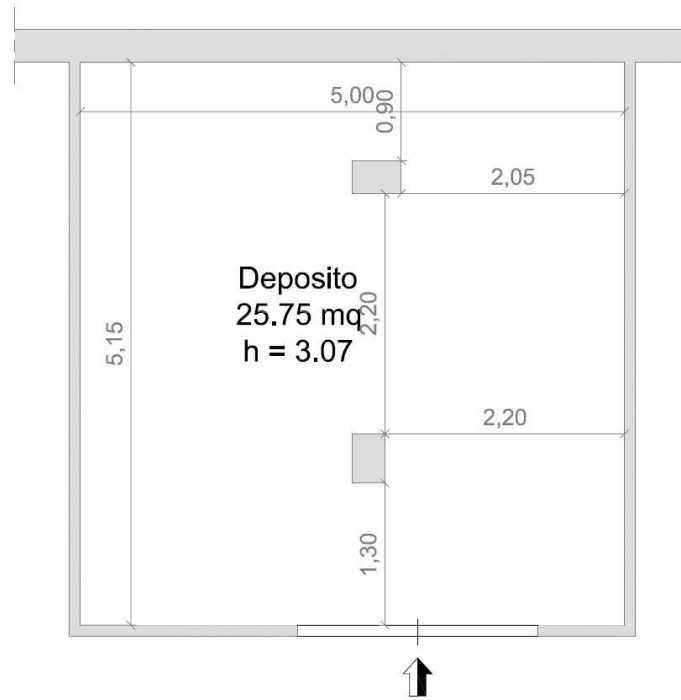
Planimetria Catastale Foglio 46, p.lla 1235, sub 17.
